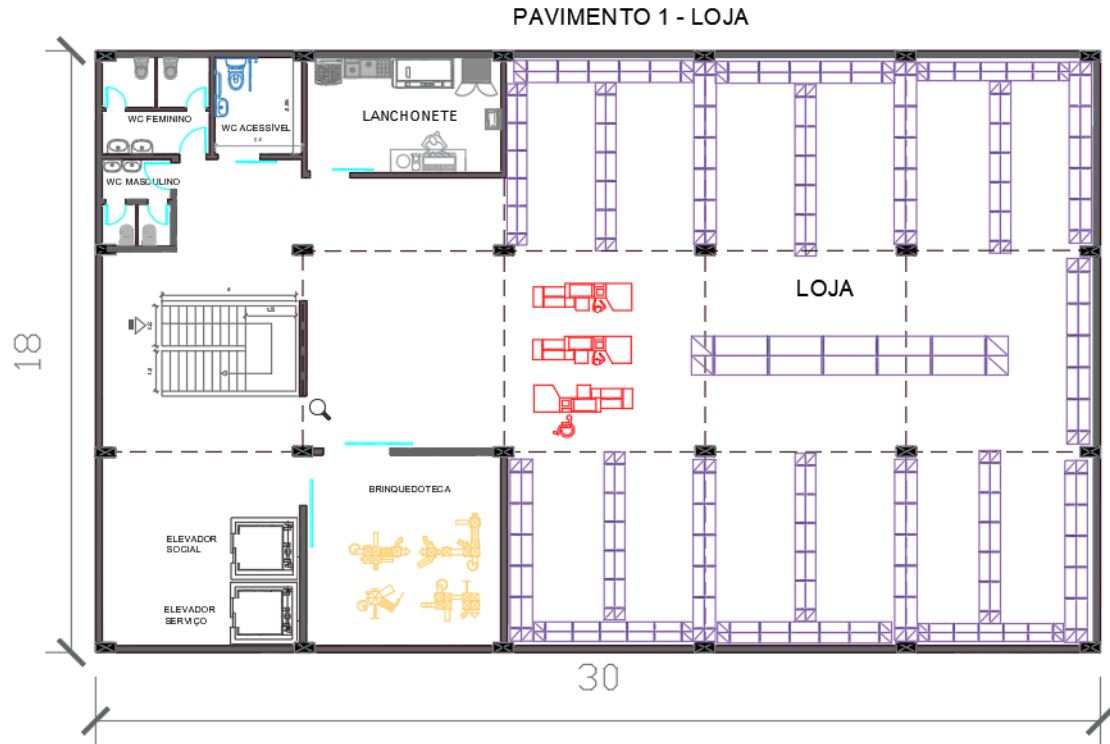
Planta do Pavimento 1º- Andar - Loja. Fonte: dos Autores, 2024.
